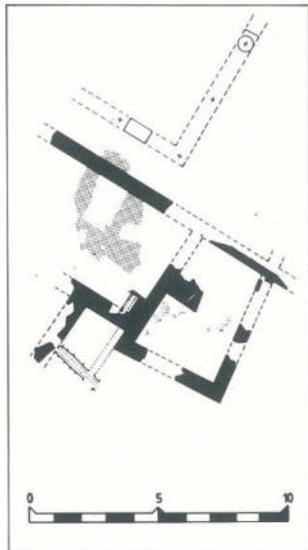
Casa a peristilio S 1 a sud dell'agorà, pianta schematica 1994.
